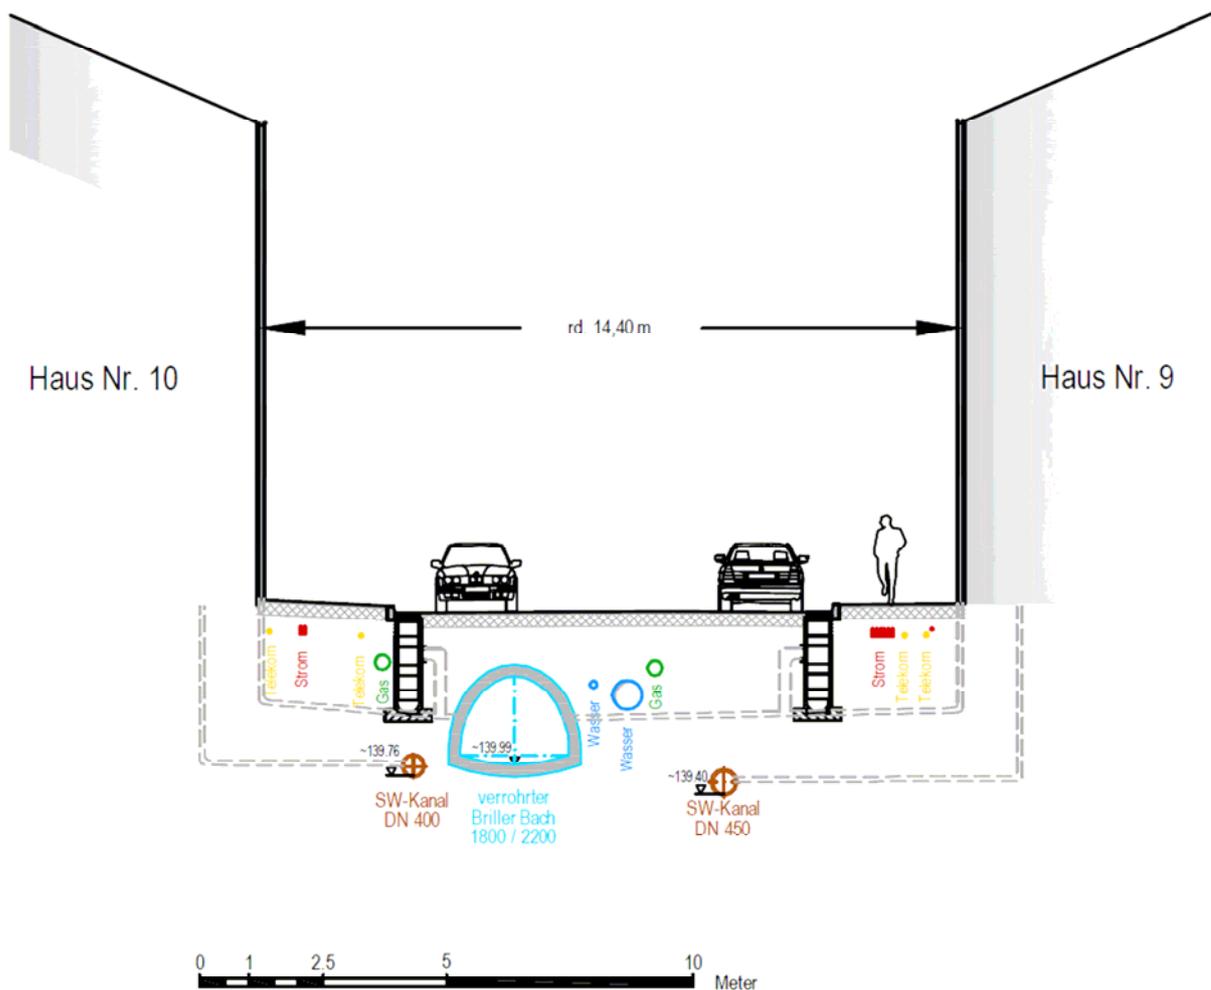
Straßenquerschnitt Briller Straße in Fließrichtung des Briller Bachs
